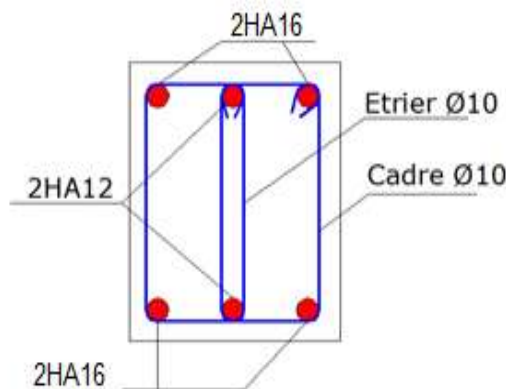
Schéma de ferrailage des poutres principales en travées et aux appuis
